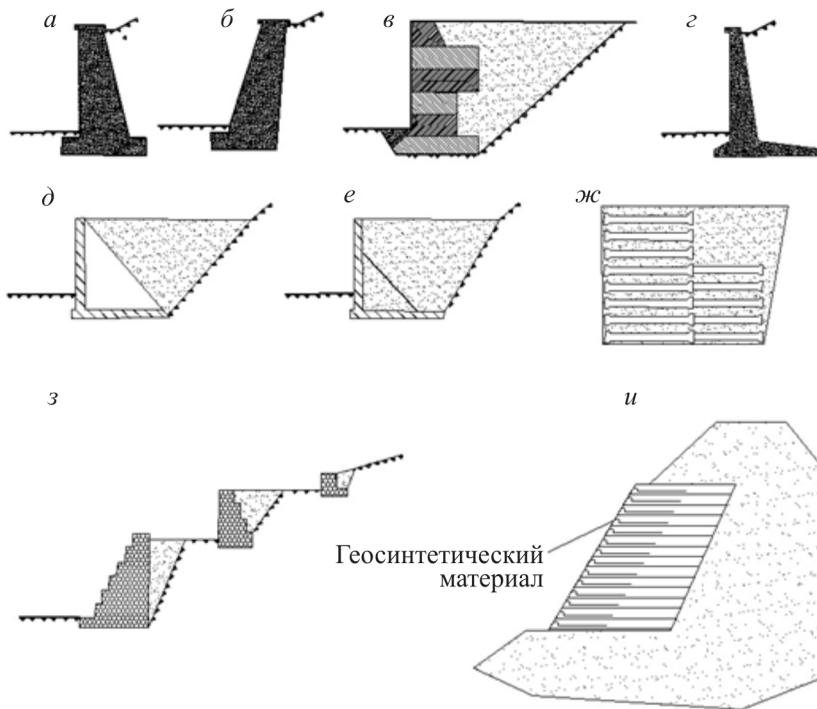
Массивные (гравитационные) сооружения: *a, б* – монолитные с вертикальной и наклонной гранью; *в* – из бетонных блоков и каменной кладки; *г, д, е* – уголкового стенки; *ж* – ряжевые; *з* – габионные; *и* – армогрунтовые насыпи
